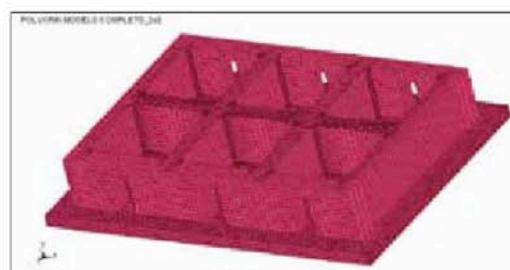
Hormigón de la losa inferior y de los muros del polvorín
